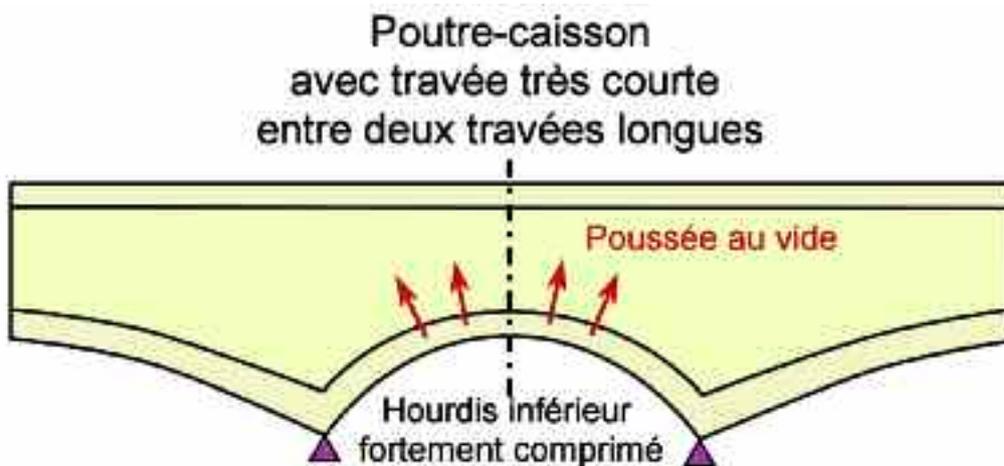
poussée au vide dans une poutre-caisson de hauteur variable
